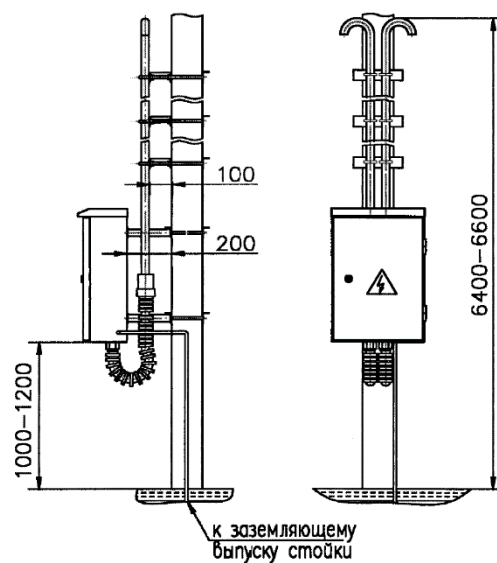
Способ установки шкафа на железобетонной опоре с вводом выводом проводов сверху шкафа.
